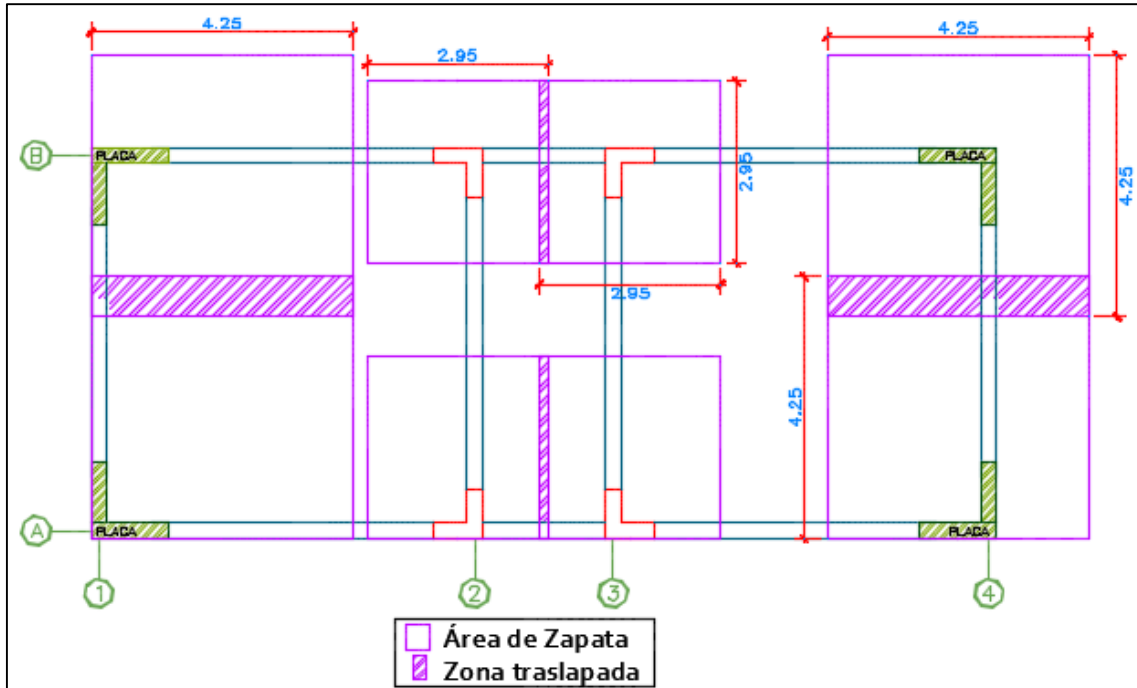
Área de contacto zapata aislada - Sistema dual tipo I
